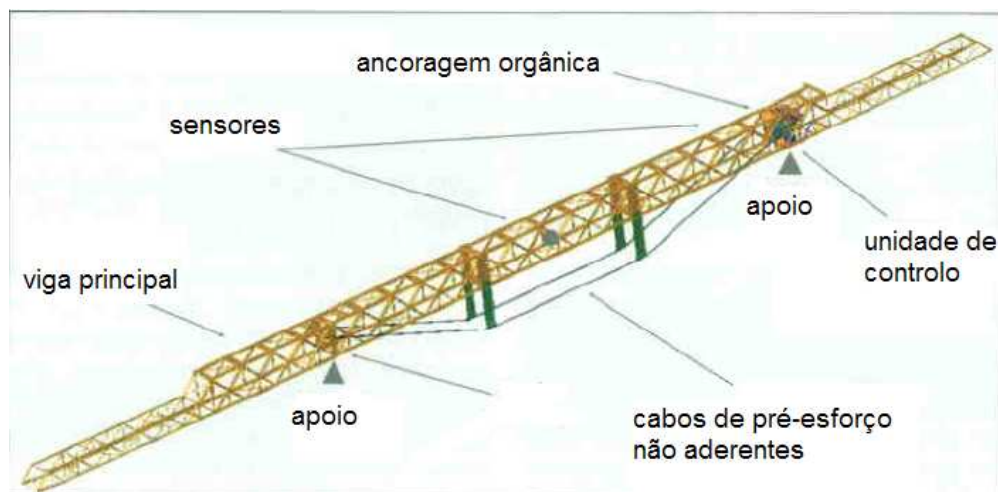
Composição das vigas metálicas que constituem o cimbra [7]
